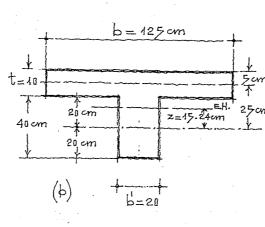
Corte de un entre-eje de la estructuro, (4).
